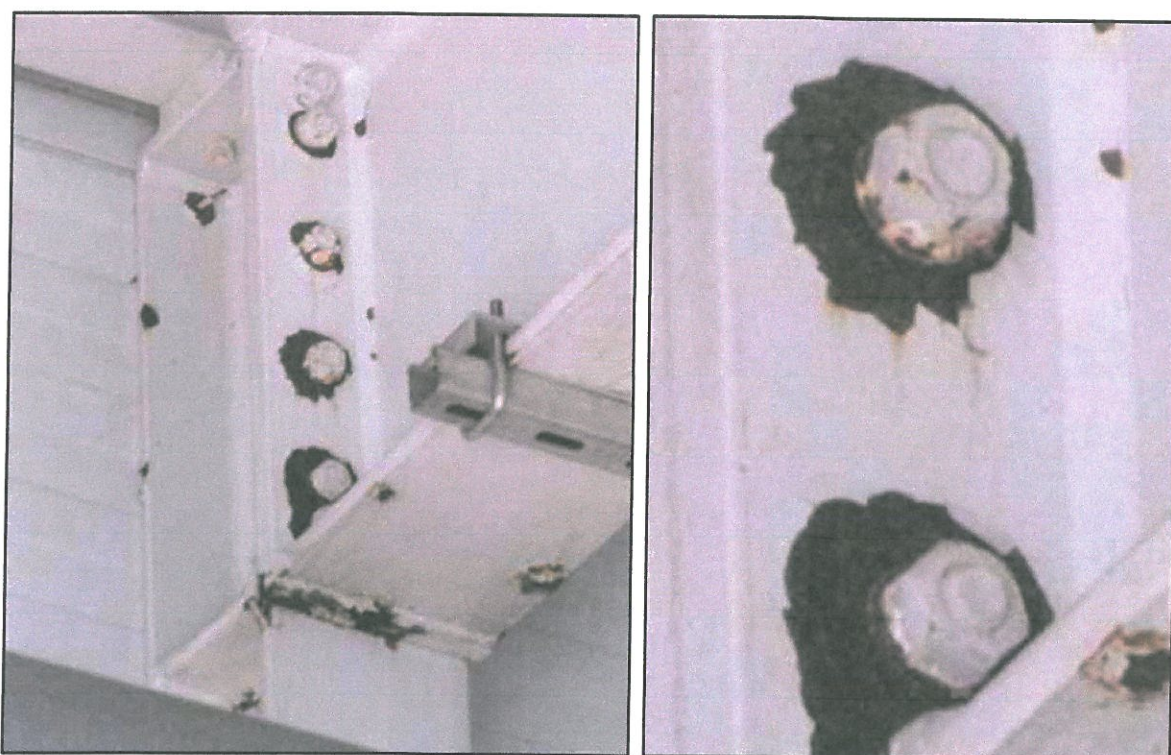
Korozja na połączeniach stężeń połaciowych (dachowych) konstrukcji nośnej hali.
